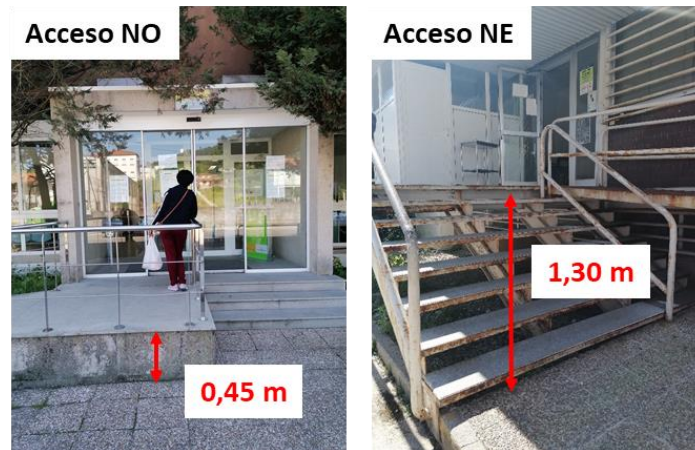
Cotas de las dos entradas a la instalación por las fachadas NO y NE (Urgencias) respectivamente
